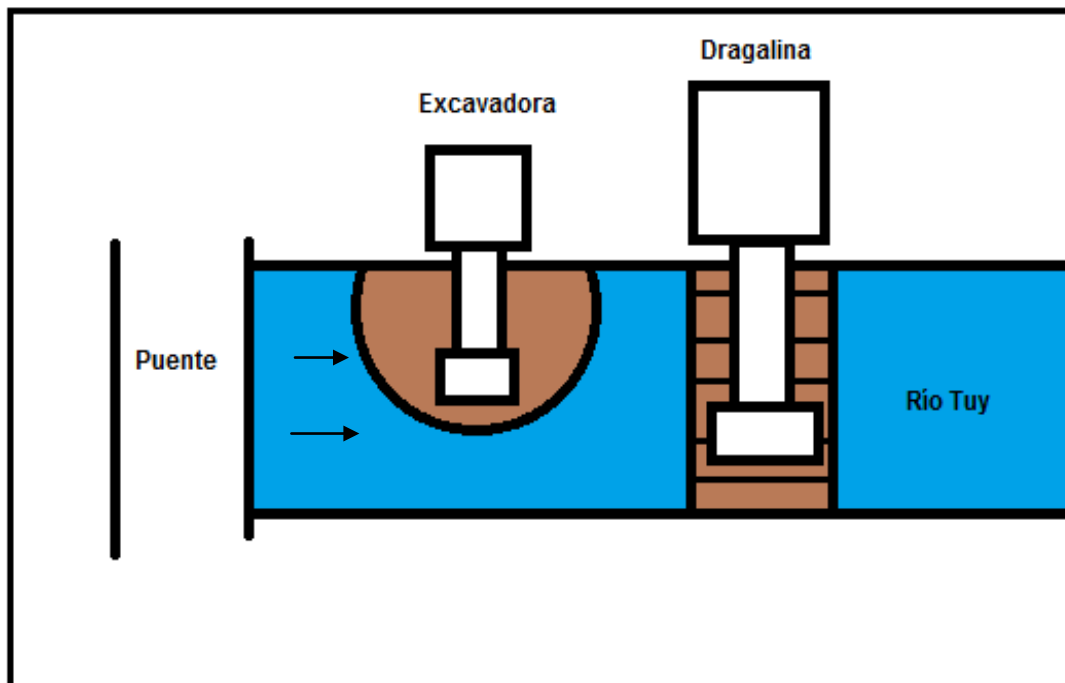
Alcance horizontal vista en planta. Fuente: Propia
